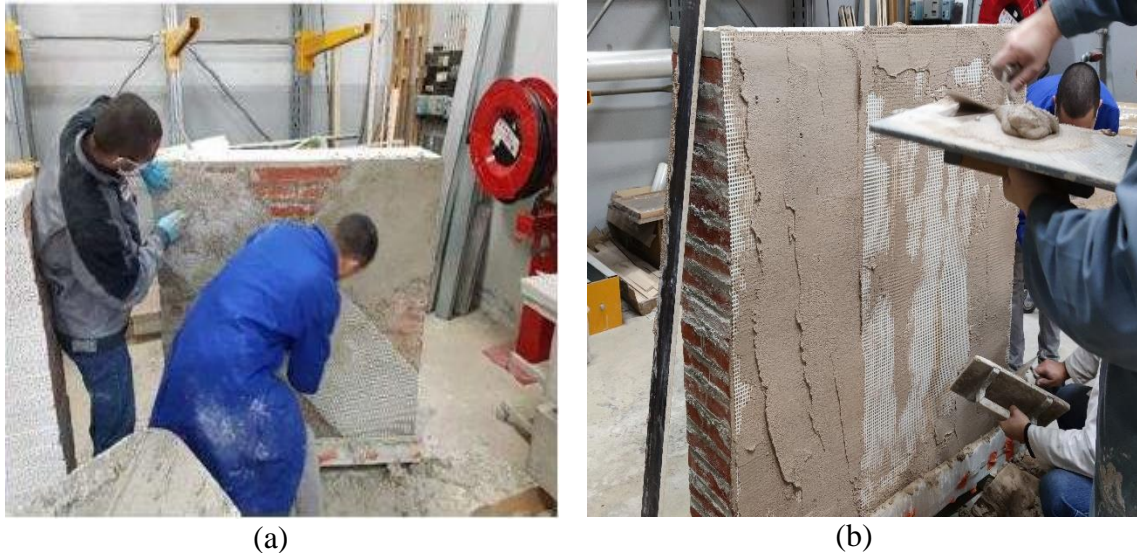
(a) Mur renforcé sur ses diagonales et (b) mur renforcé sur toute sa surface [42]
